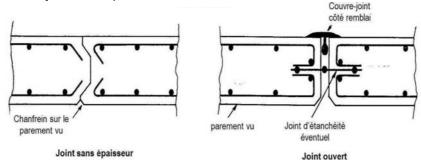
exemple de mise en place de joint sur les murs de soutènement
